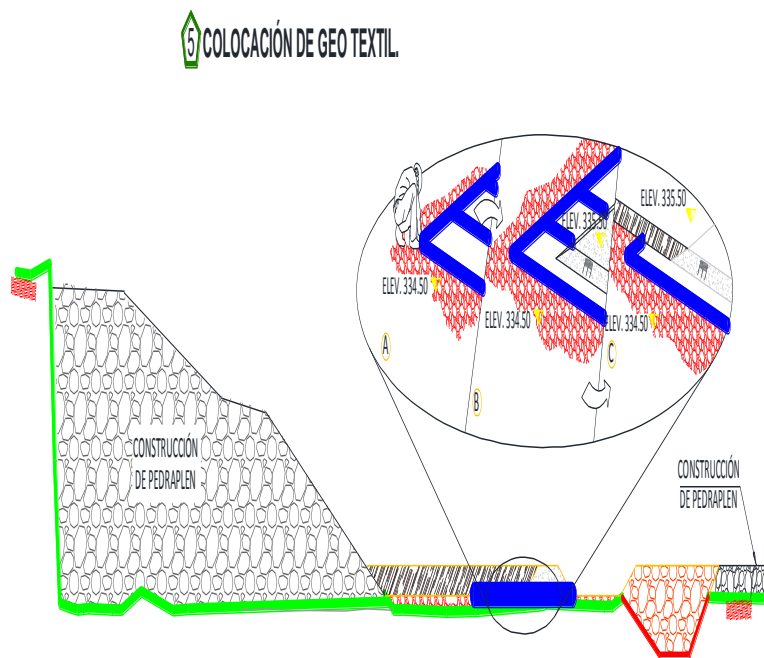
Colocación de geo textil de espigones 1 y 2.
